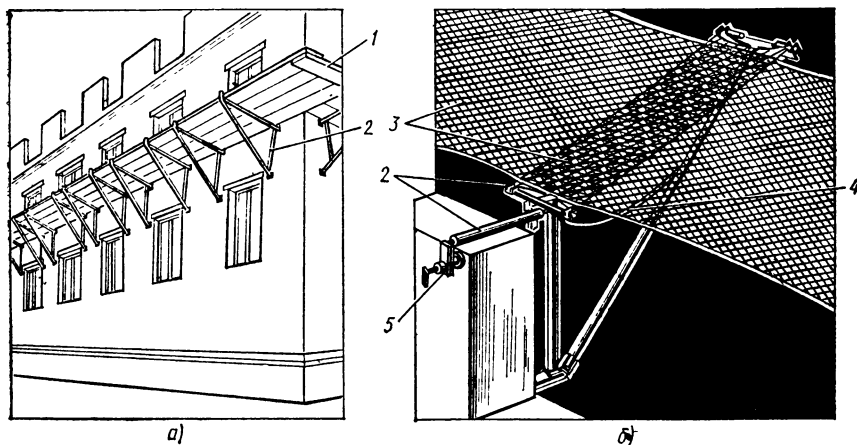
Защитные устройства, используемые при кладке стен многоэтажного здания:
